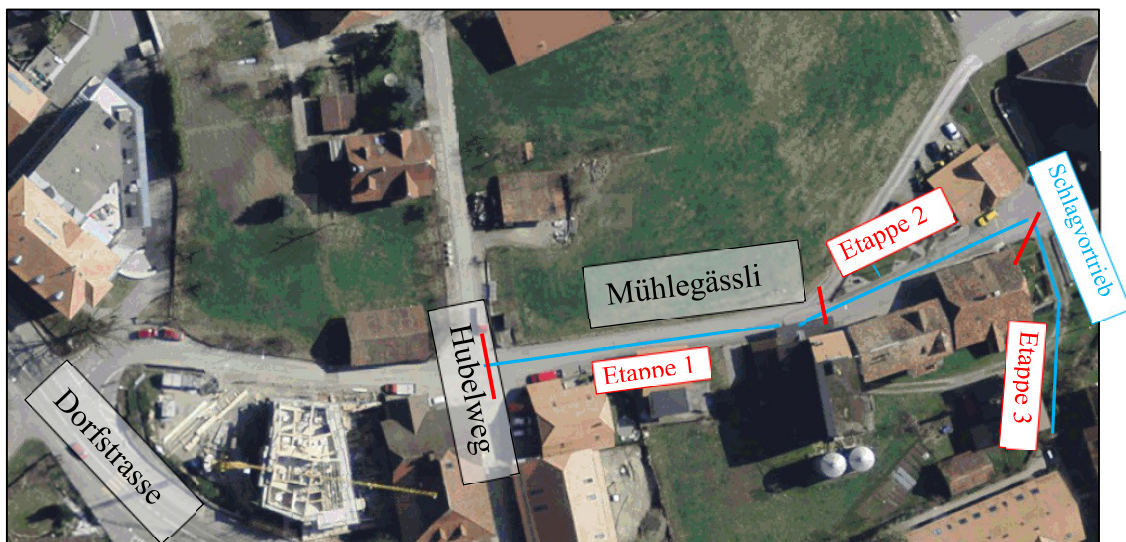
Orthophoto mit der projektierten Wasserleitung
